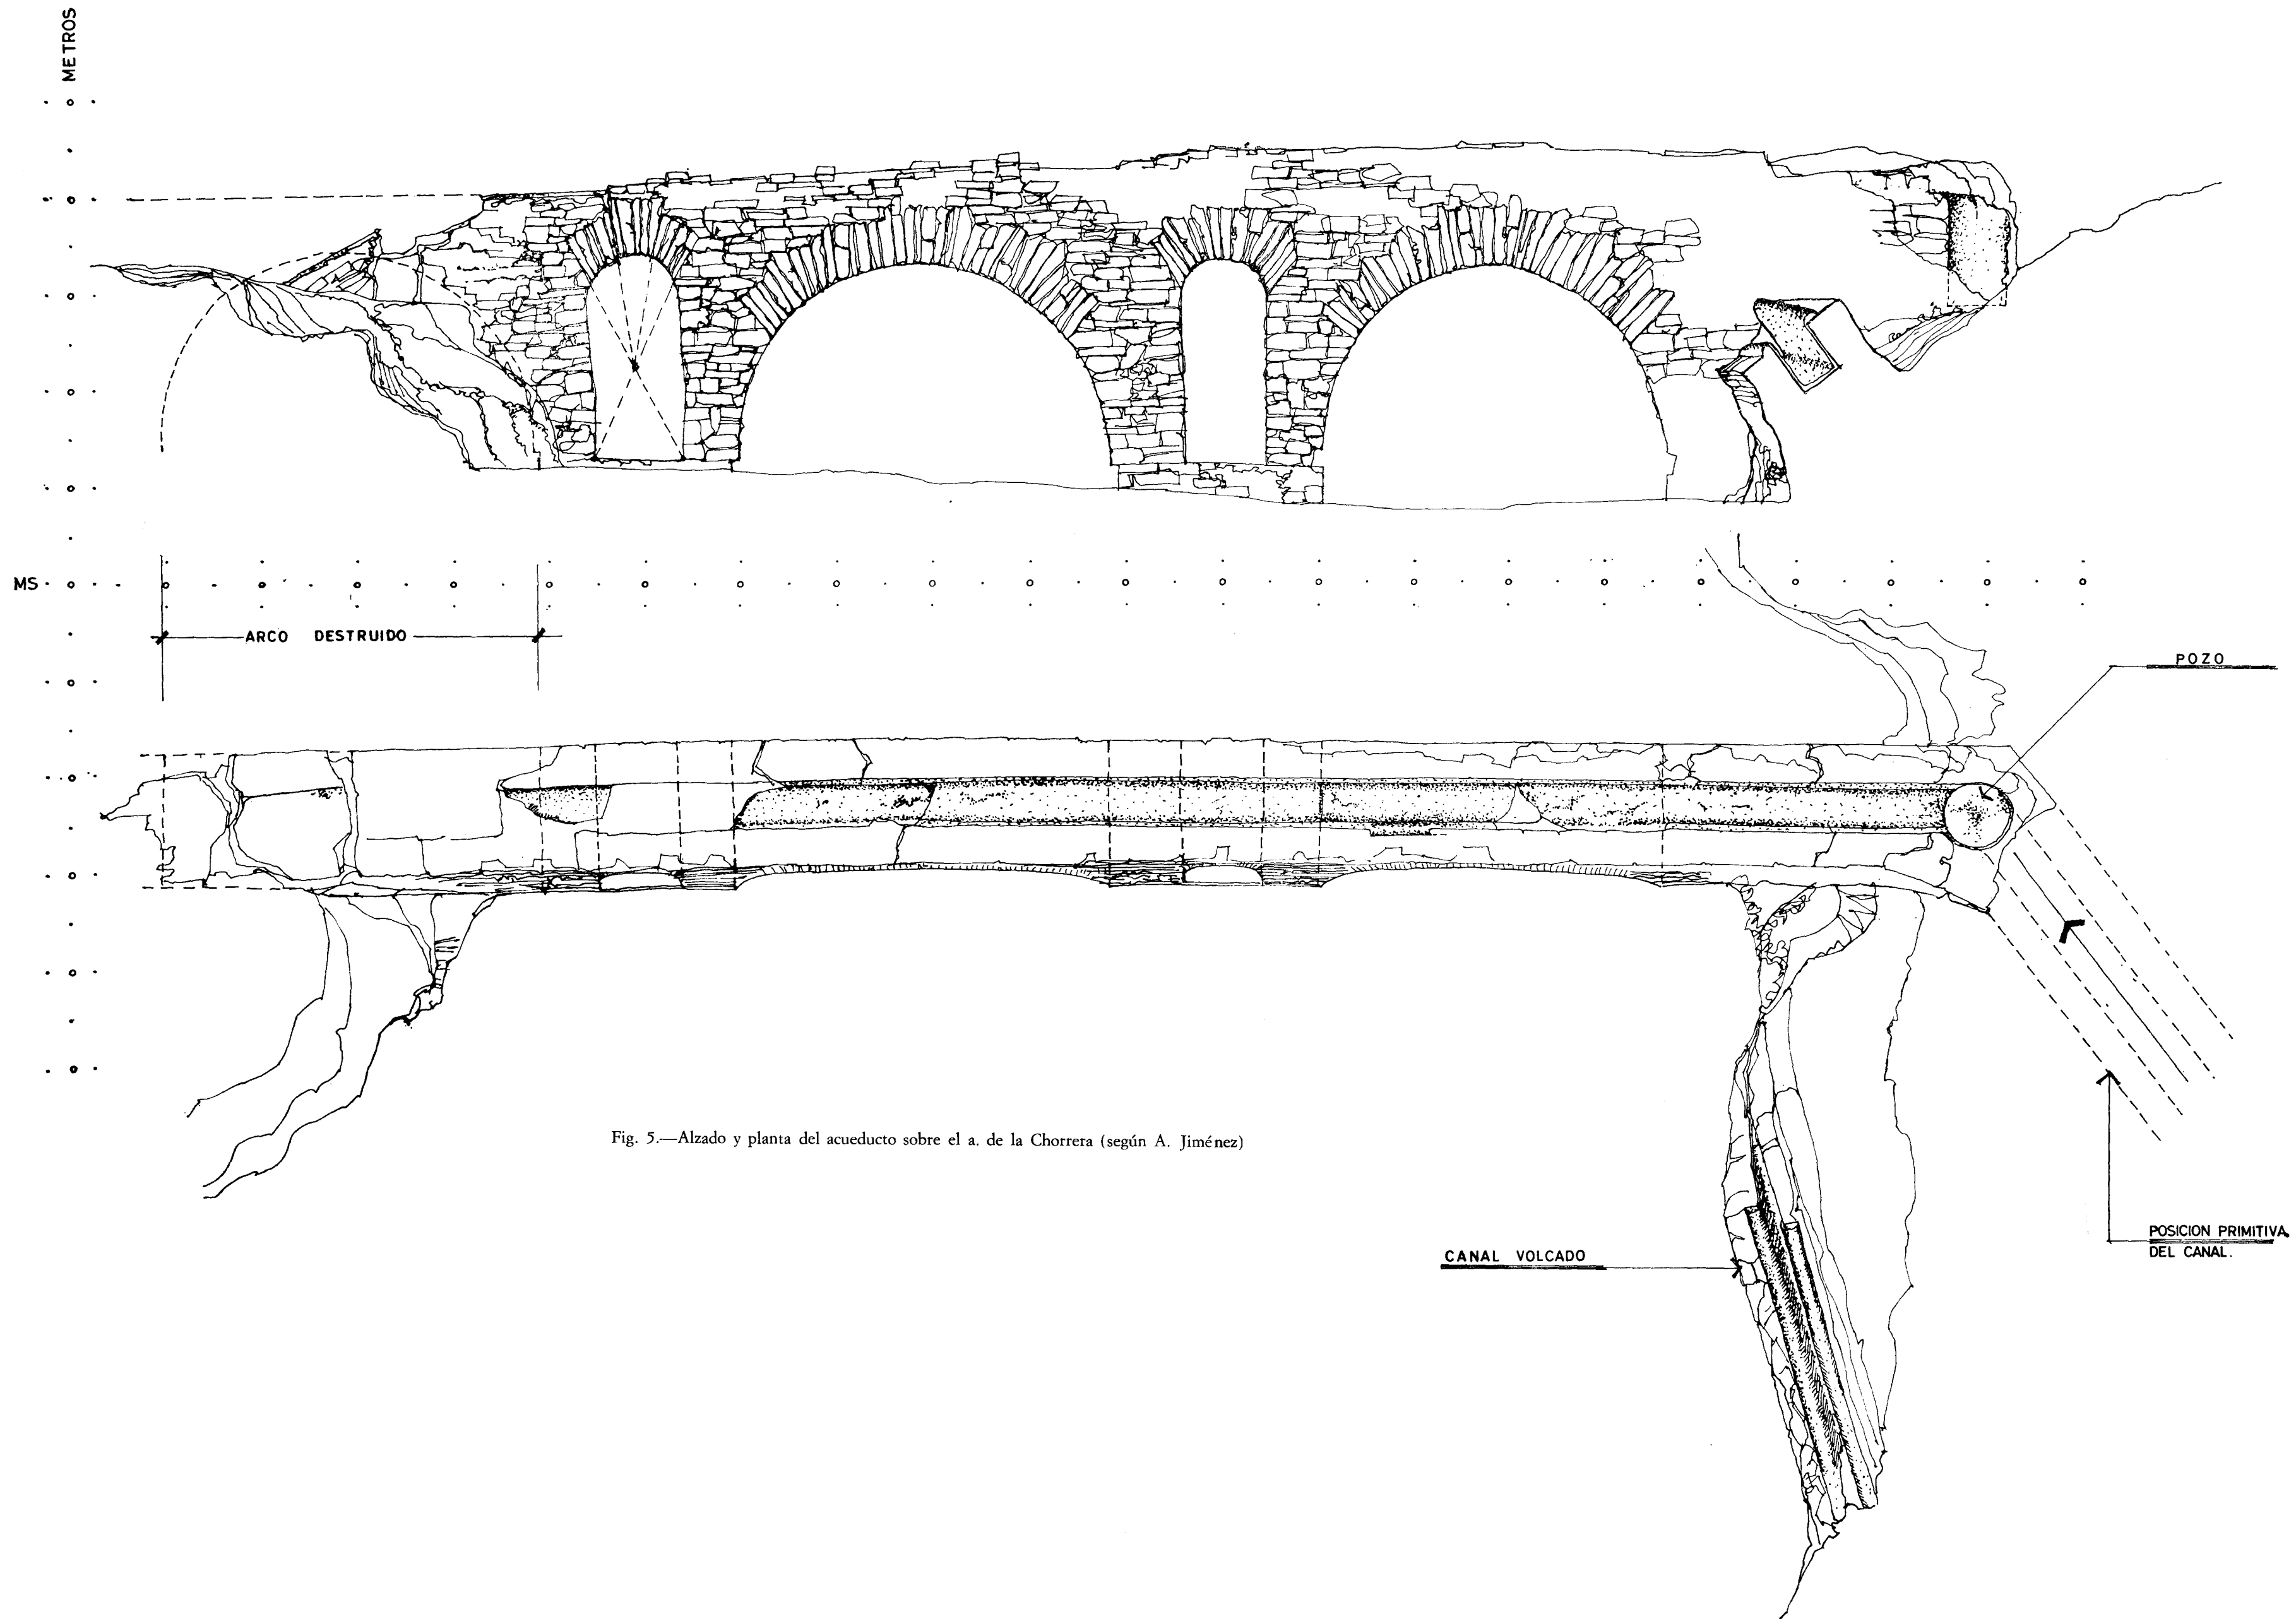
Alzado y planta del acueducto sobre el a. de la Chorrera (según A. Jiménez)
